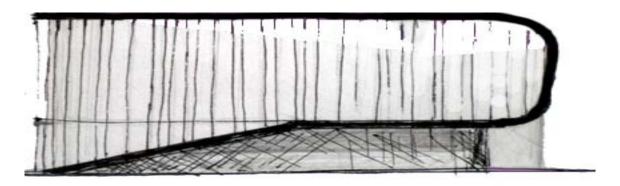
Segundo boceto de propuesta para fachada principal (este).
